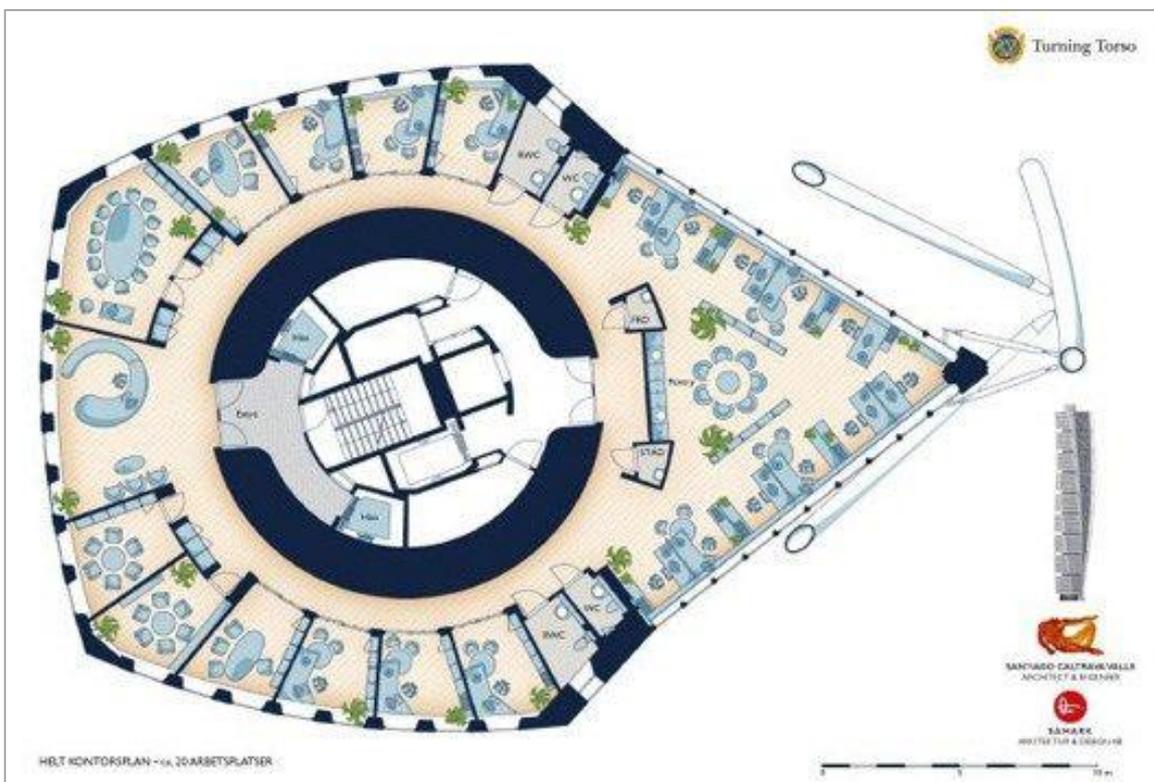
Plan d'aménagement de l'un des plateaux de la tour Turning Torso.
